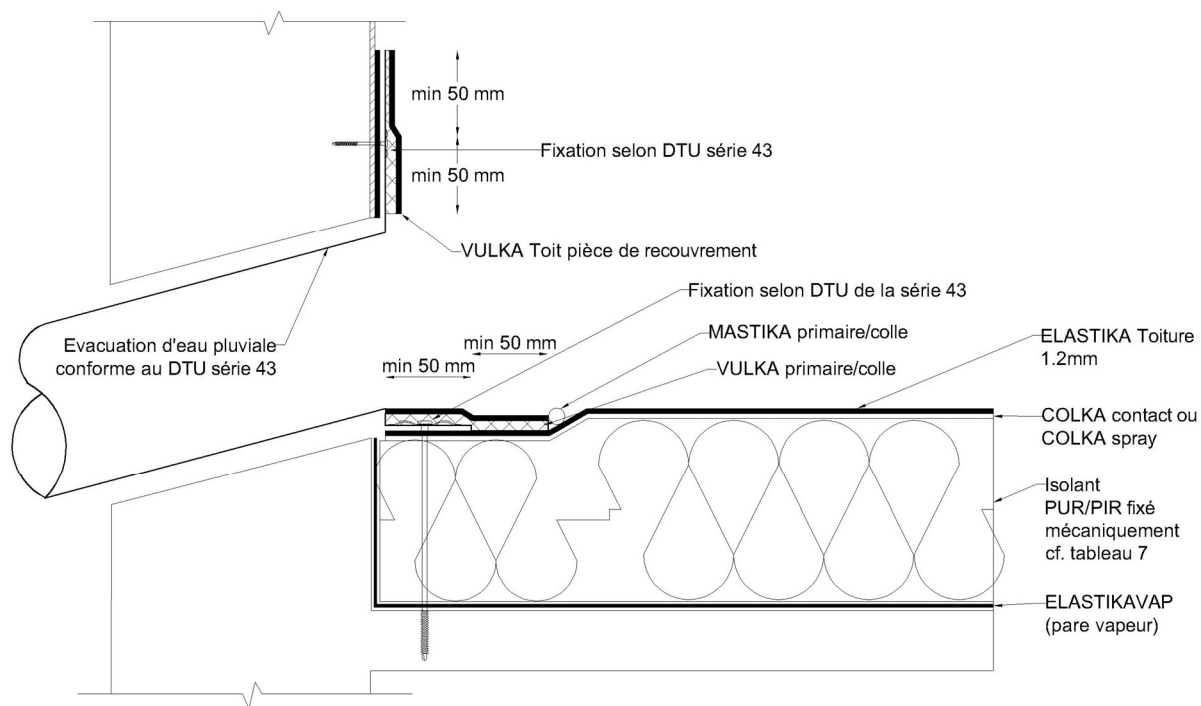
Exemple de traitement d'une évacuation d'eau pluviale sur relevé
